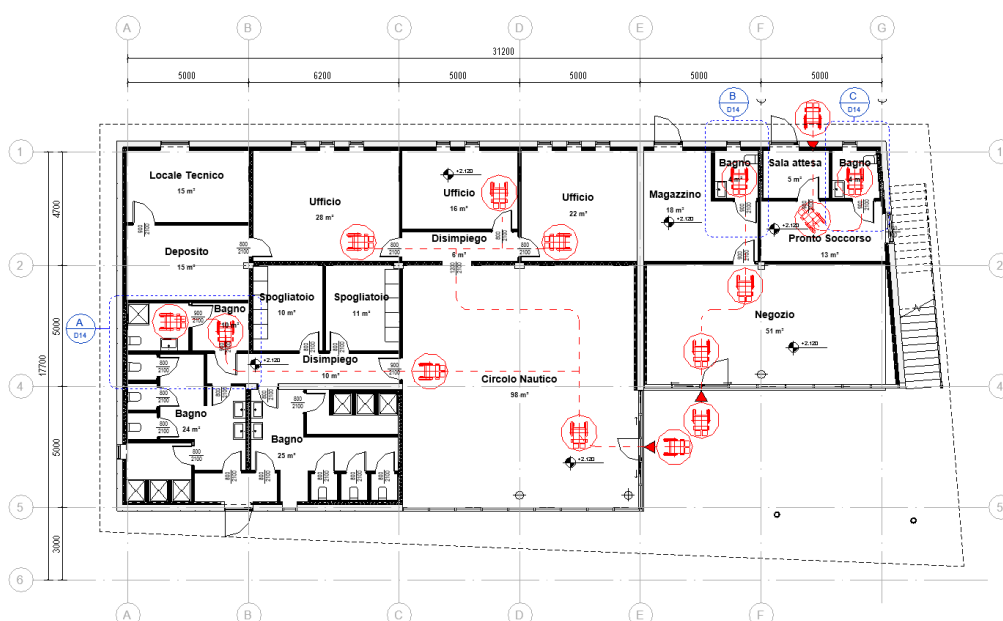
Pianta superamento barriere architettoniche – Circolo Nautico
